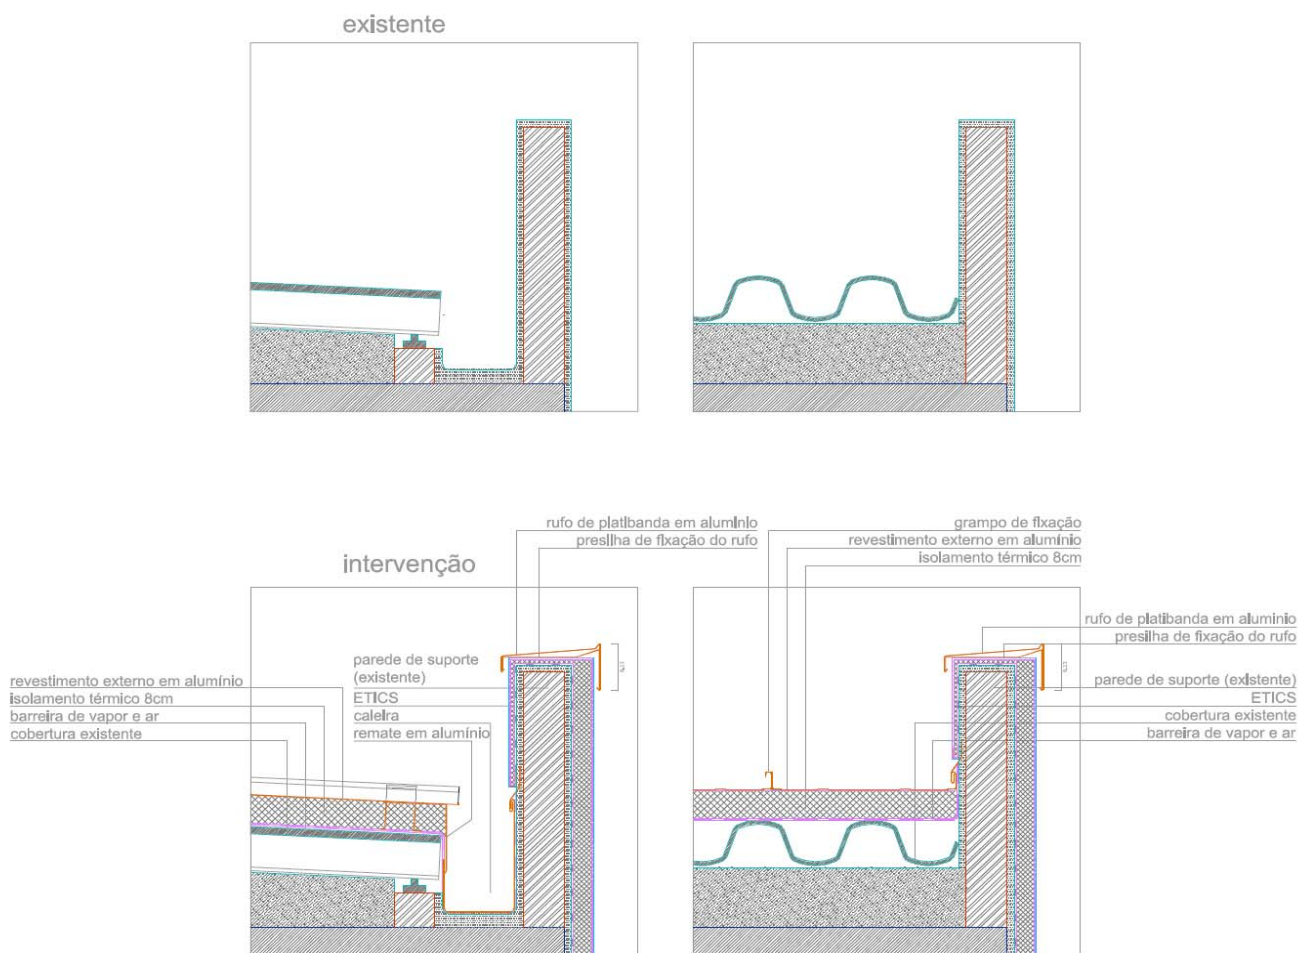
Platibanda. Pormenores construtivos da cobertura (escala 1/20).
